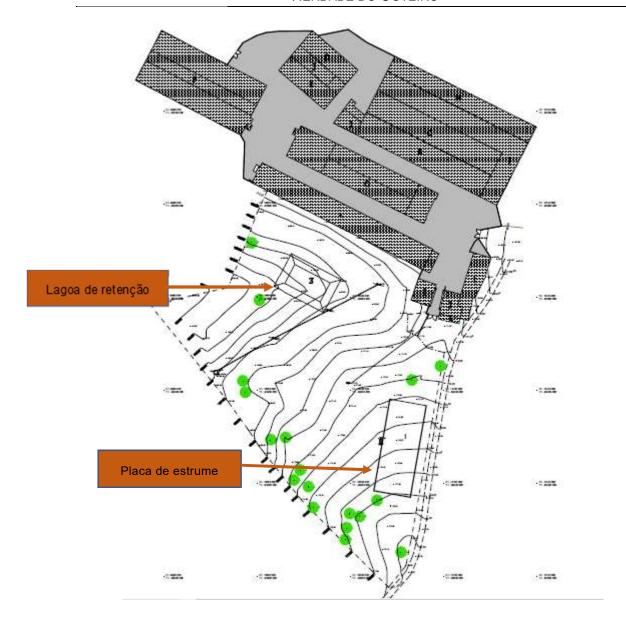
Planta de Implantação da pecuária e do sistema de retenção de efluentes pecuários.
